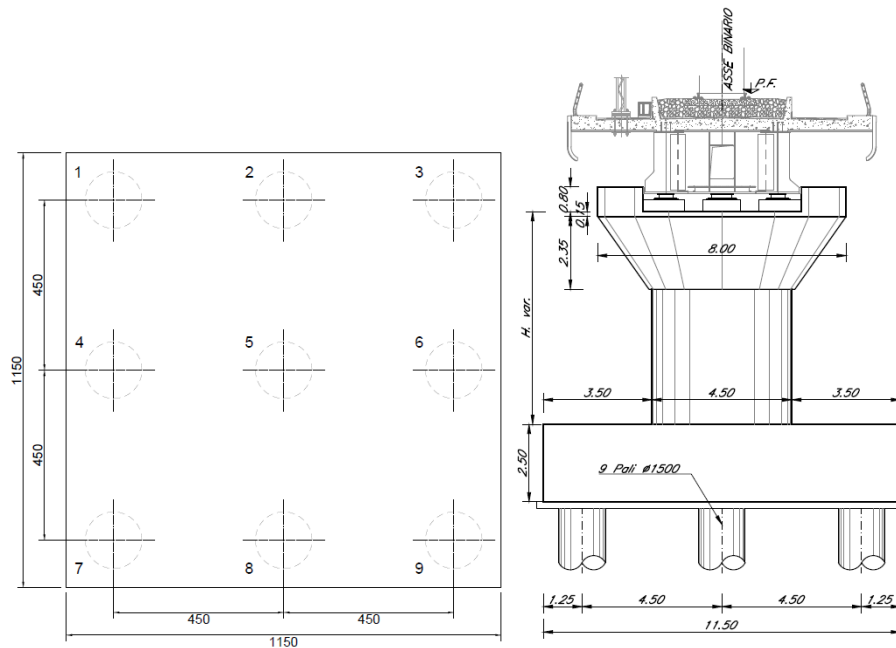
stralcio della carpenteria pila e fondazione da n°9 pali
